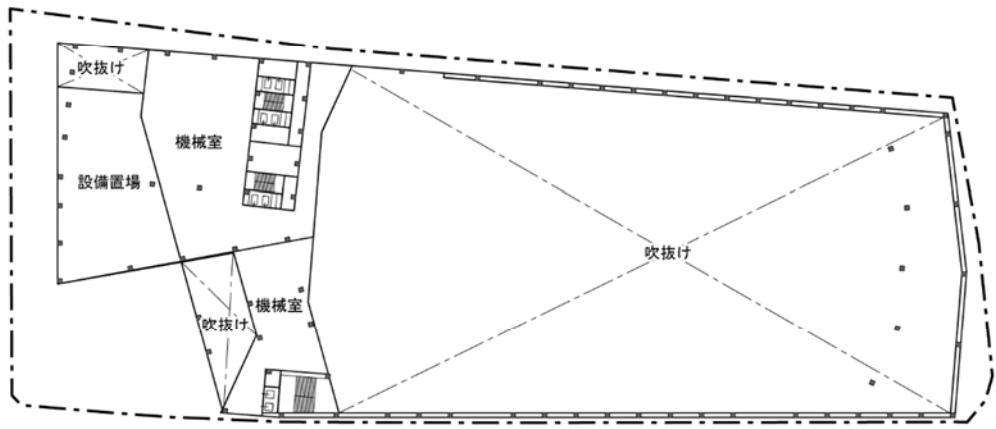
(4) 各階平面図 (アリーナ敷地 : 6階、7階)
